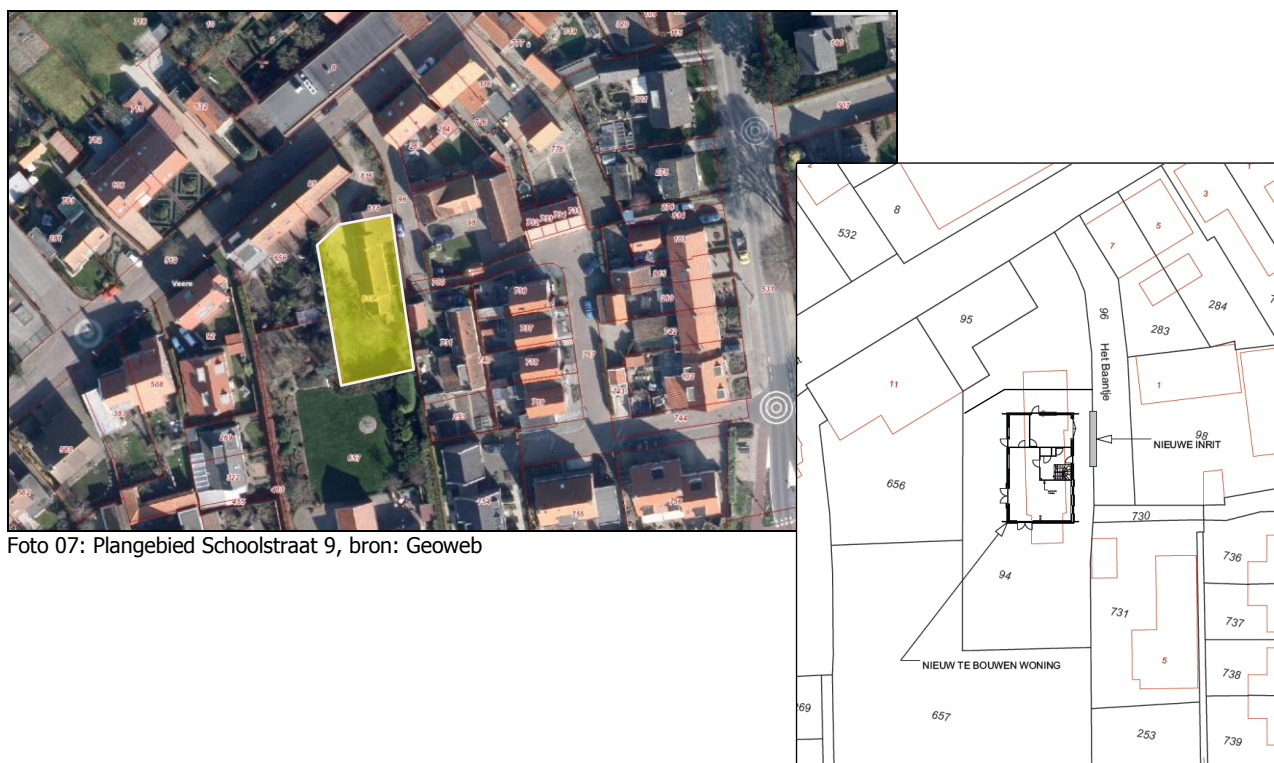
Plangebied Schoolstraat 9, bron: Geoweb
